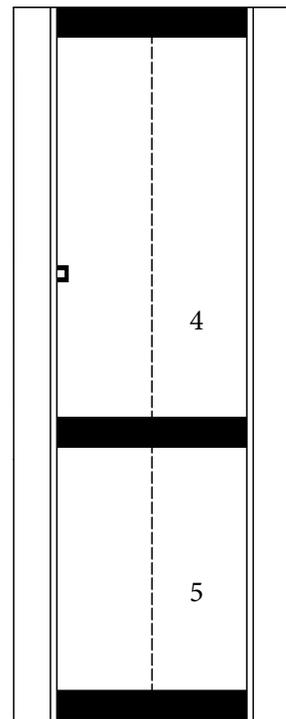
Dachgeschoss 1. Bauphase 1:200
